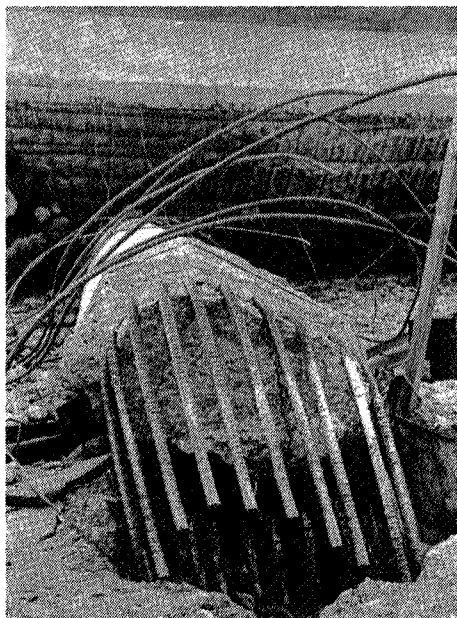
Arrachement d'une pile par dislocation de la tête de son pieu de fondation, au pont no. 2, "IS 210/5 Separation and Overhead Structure". San Fernando (1971). D'après Lew et al. (1971).
